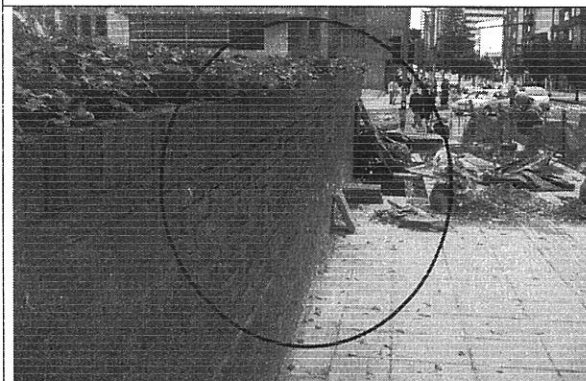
Pérdida de verticalidad en el muro de la carrera 13
